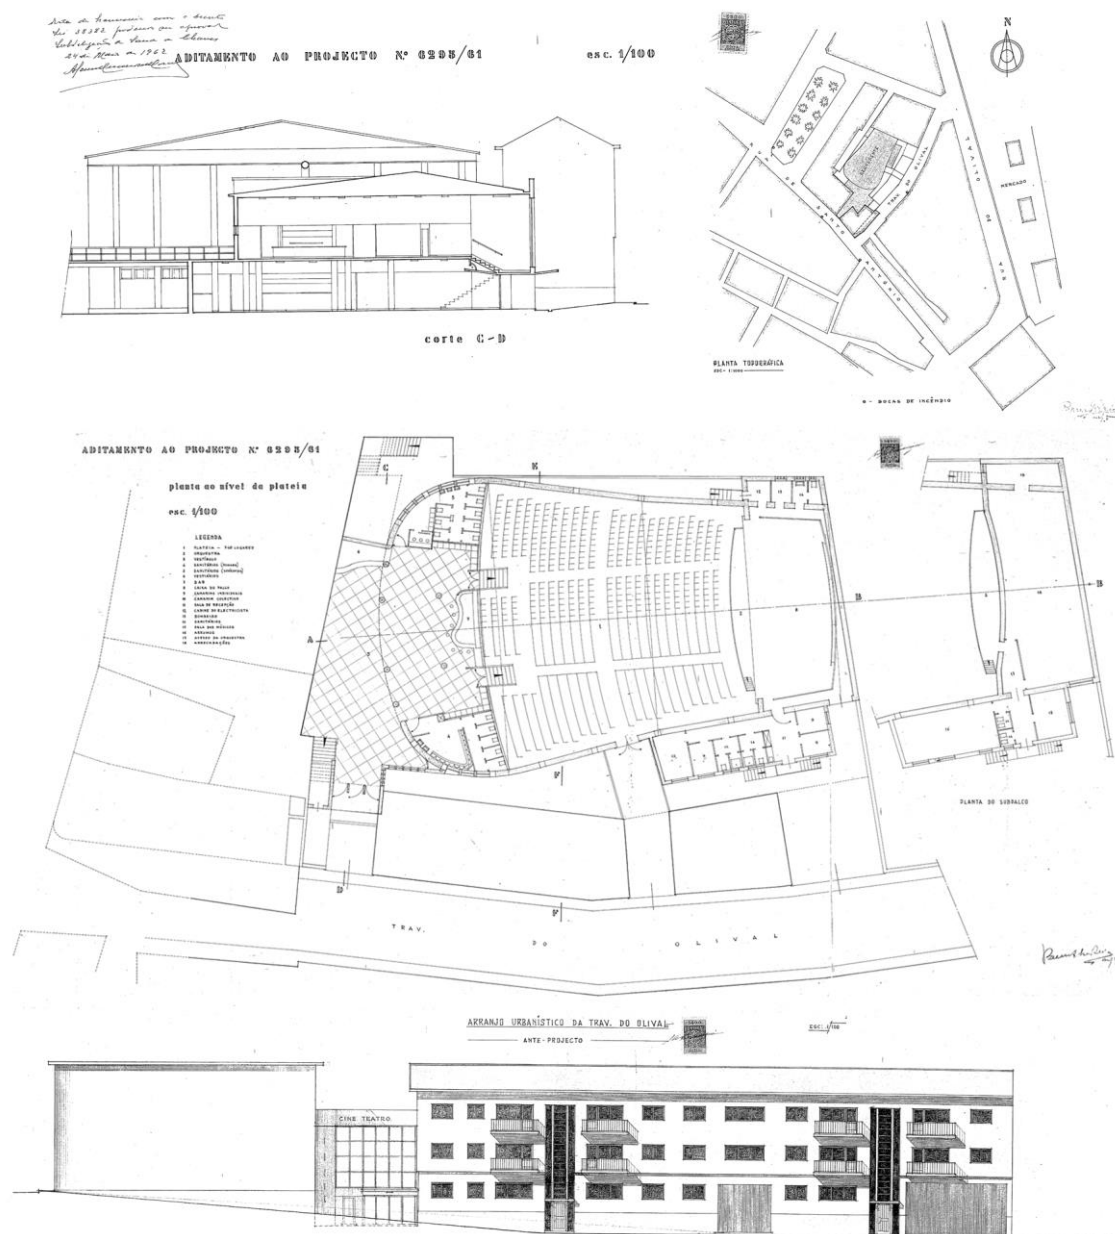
Planta ao nível da plateia e alçado, projeto de Bruno Alves Reis.
